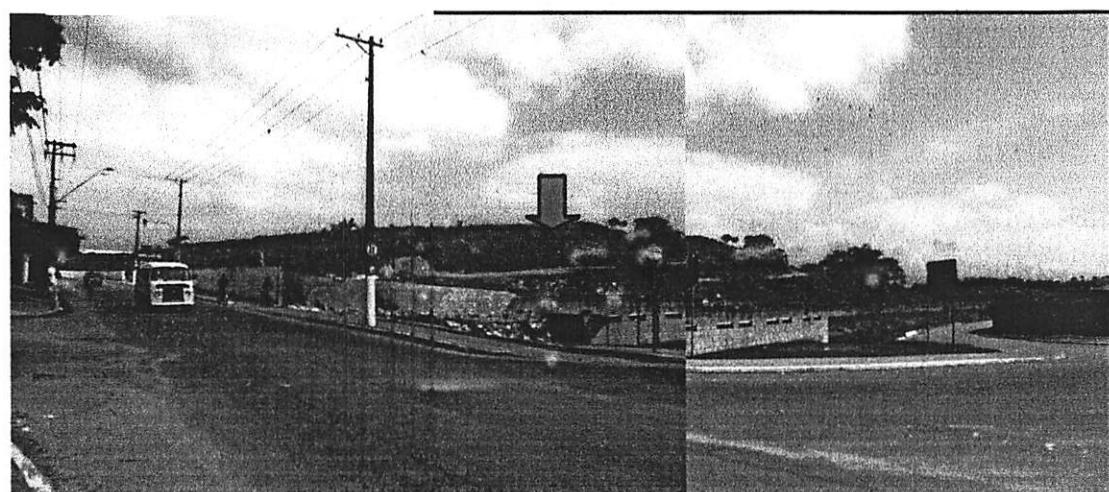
Observador na Av. do Trabalhador com vista para o aterro sanitário do "Lixão" onde se situa os lotes em estudos
